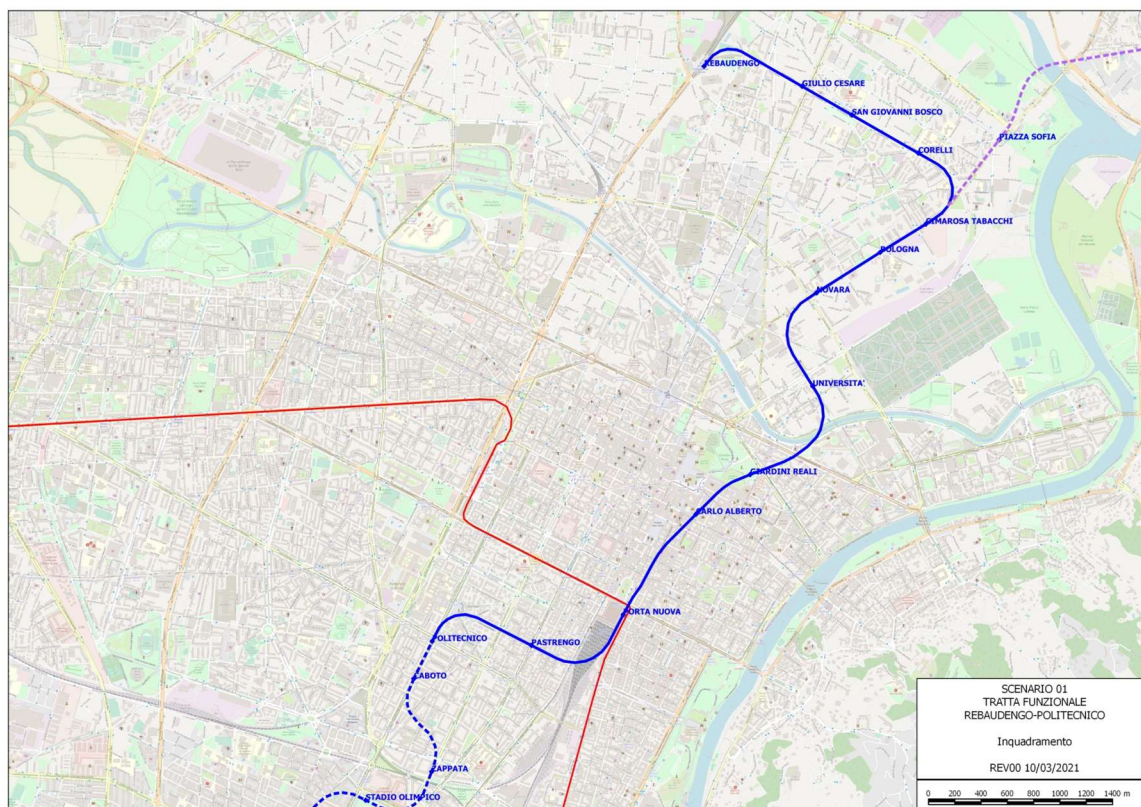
Key-plan della linea 2 – Lotto funzionale 1 – Rebaudengo - Bologna
